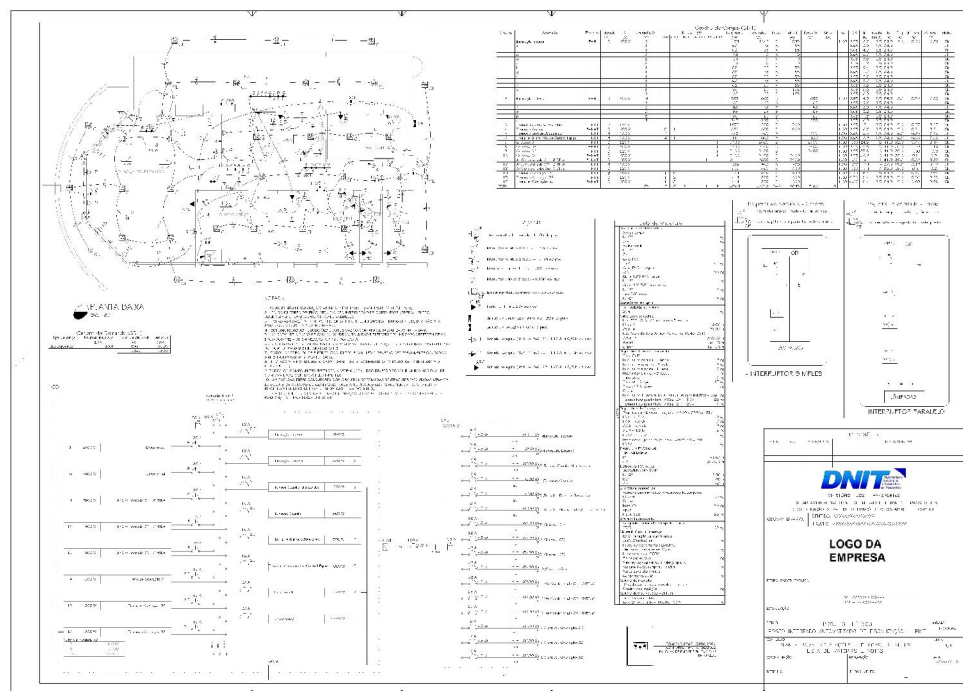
Planta baixa instalações elétricas, detalhes, lista de materiais e notas.
